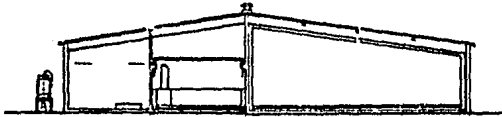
Planta tipo de Refrigeración Industrial (3)
